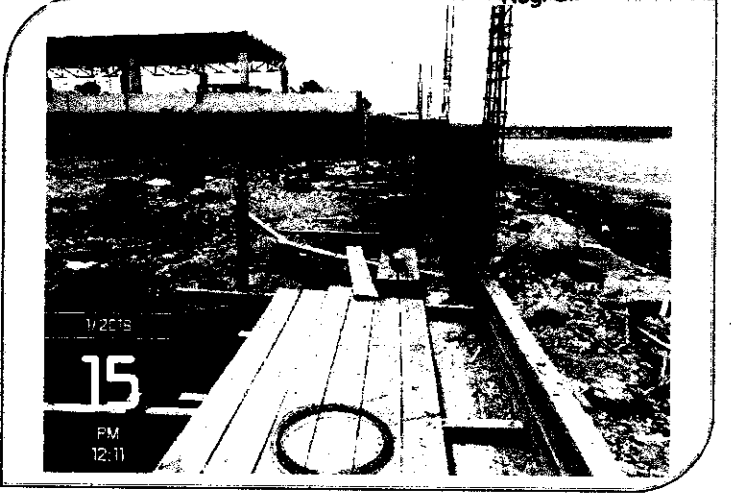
Se continua con el asentado de ladrillo en muro de zona de Descarga en Sector N°03.
